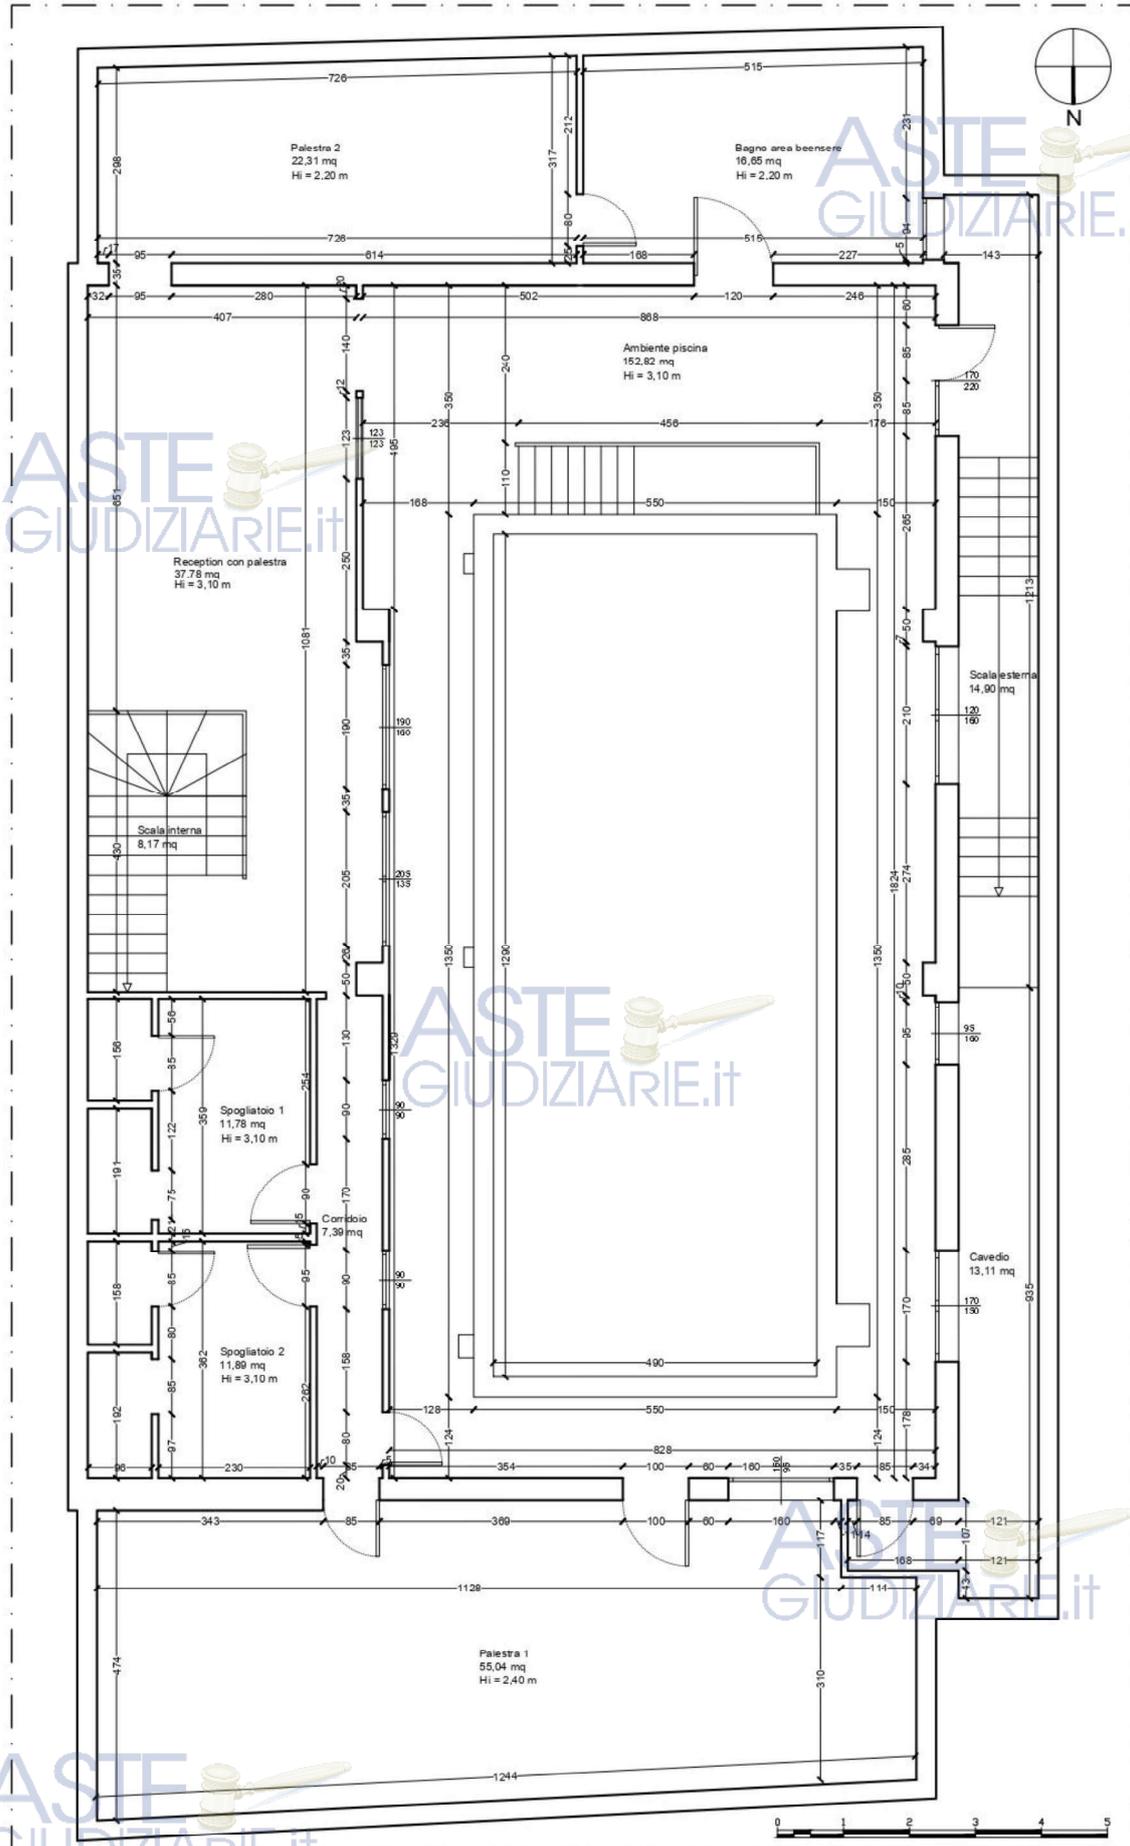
Planimetria stato di fatto – unità immobiliare oggetto di elaborato peritale
